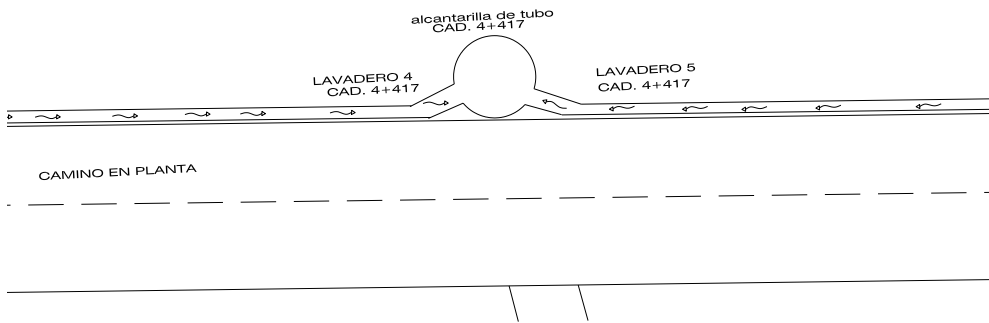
Ubicación de lavaderos 4 y 5 salida hacia alcantarilla de tubo cad. 4+417.
